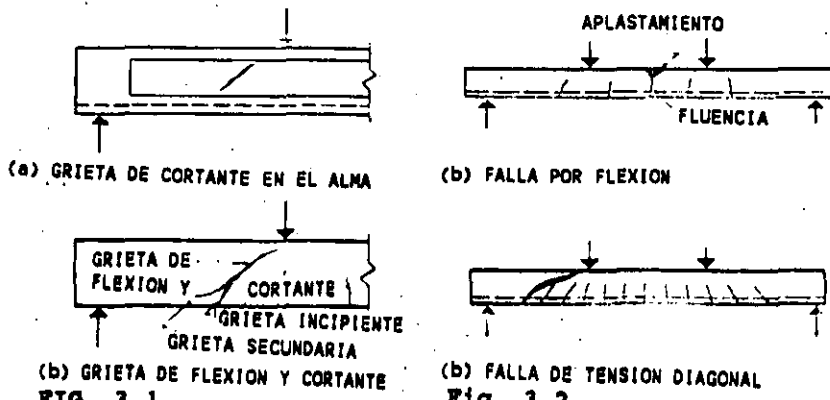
Tipos de Grietas Inclinas
